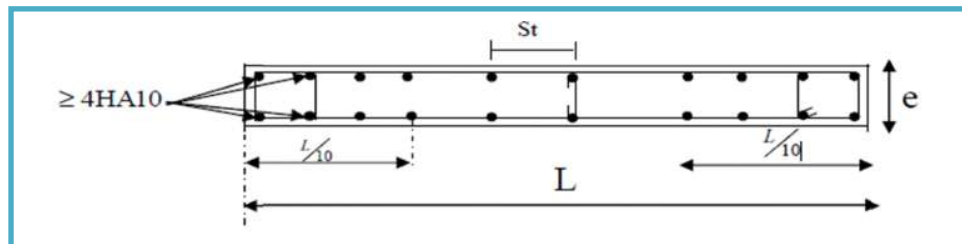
Disposition des armatures verticales dans les voiles.
